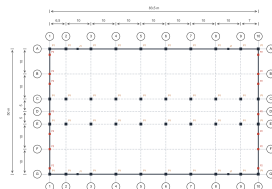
Planta de ejes — 10 marcos, separación 10 m (1.^{er} vano 6,5 m; último 7 m).
